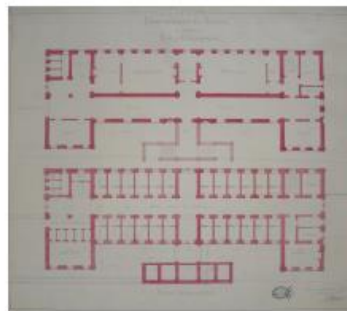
Plans du soubassement et du rez-de-chaussée, Projet de construction de l'établissement thermal du Bouridé, 1874.
